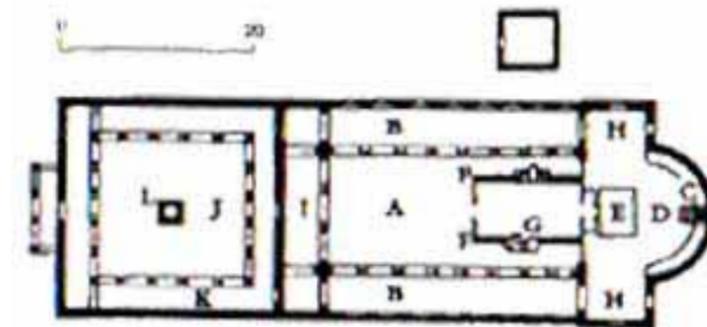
klassischer Grundriss einer frühchristlichen Basilika
